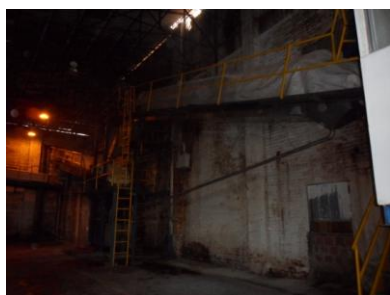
Parte de elaboración en Bodega Foto 2. Puerta 2 Junto a la Bagacera
